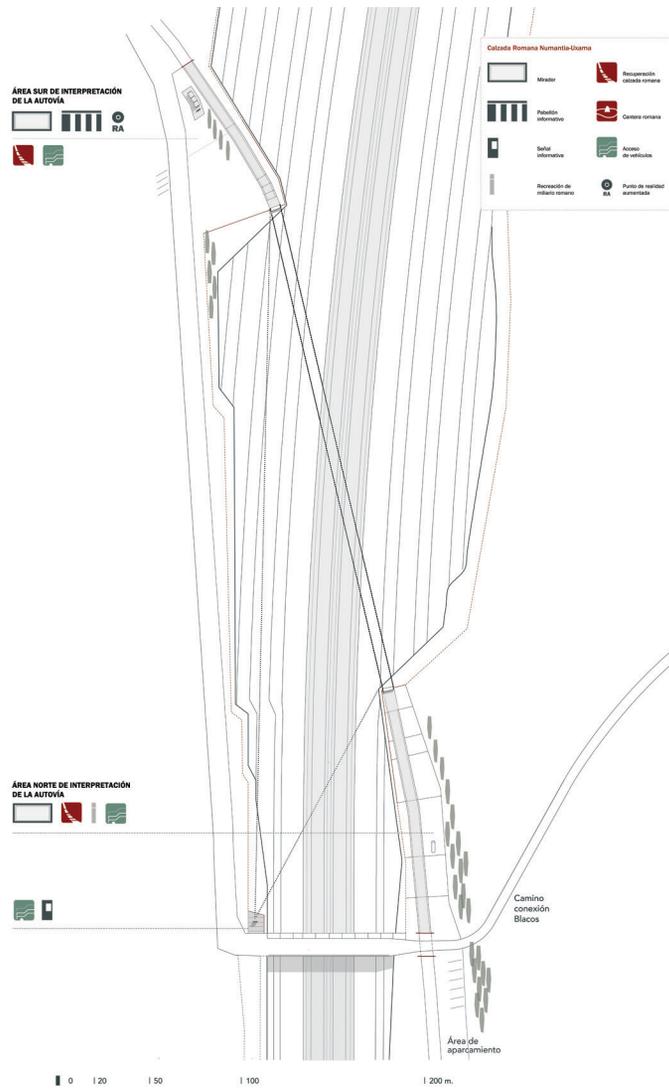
Planta general del área de la autovía con las intervenciones arquitectónicas. Fuente: LAB/PAP.
